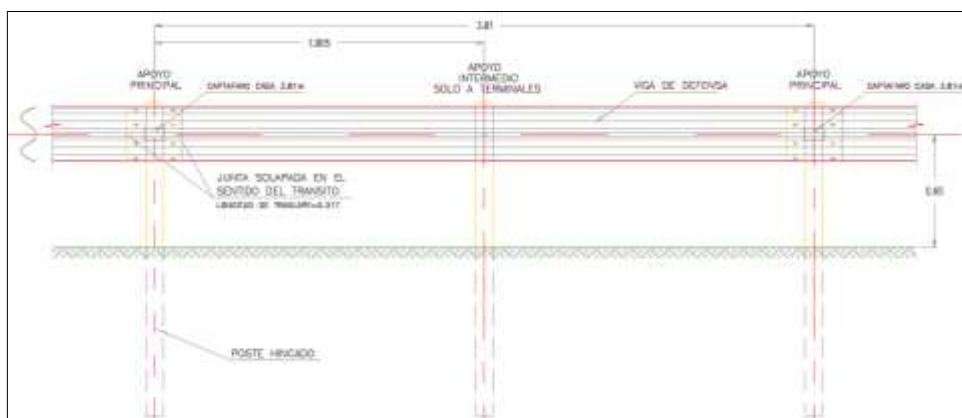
Guardavias metálico. Fuente:Plano de detalles de Guardavias Metalicos
